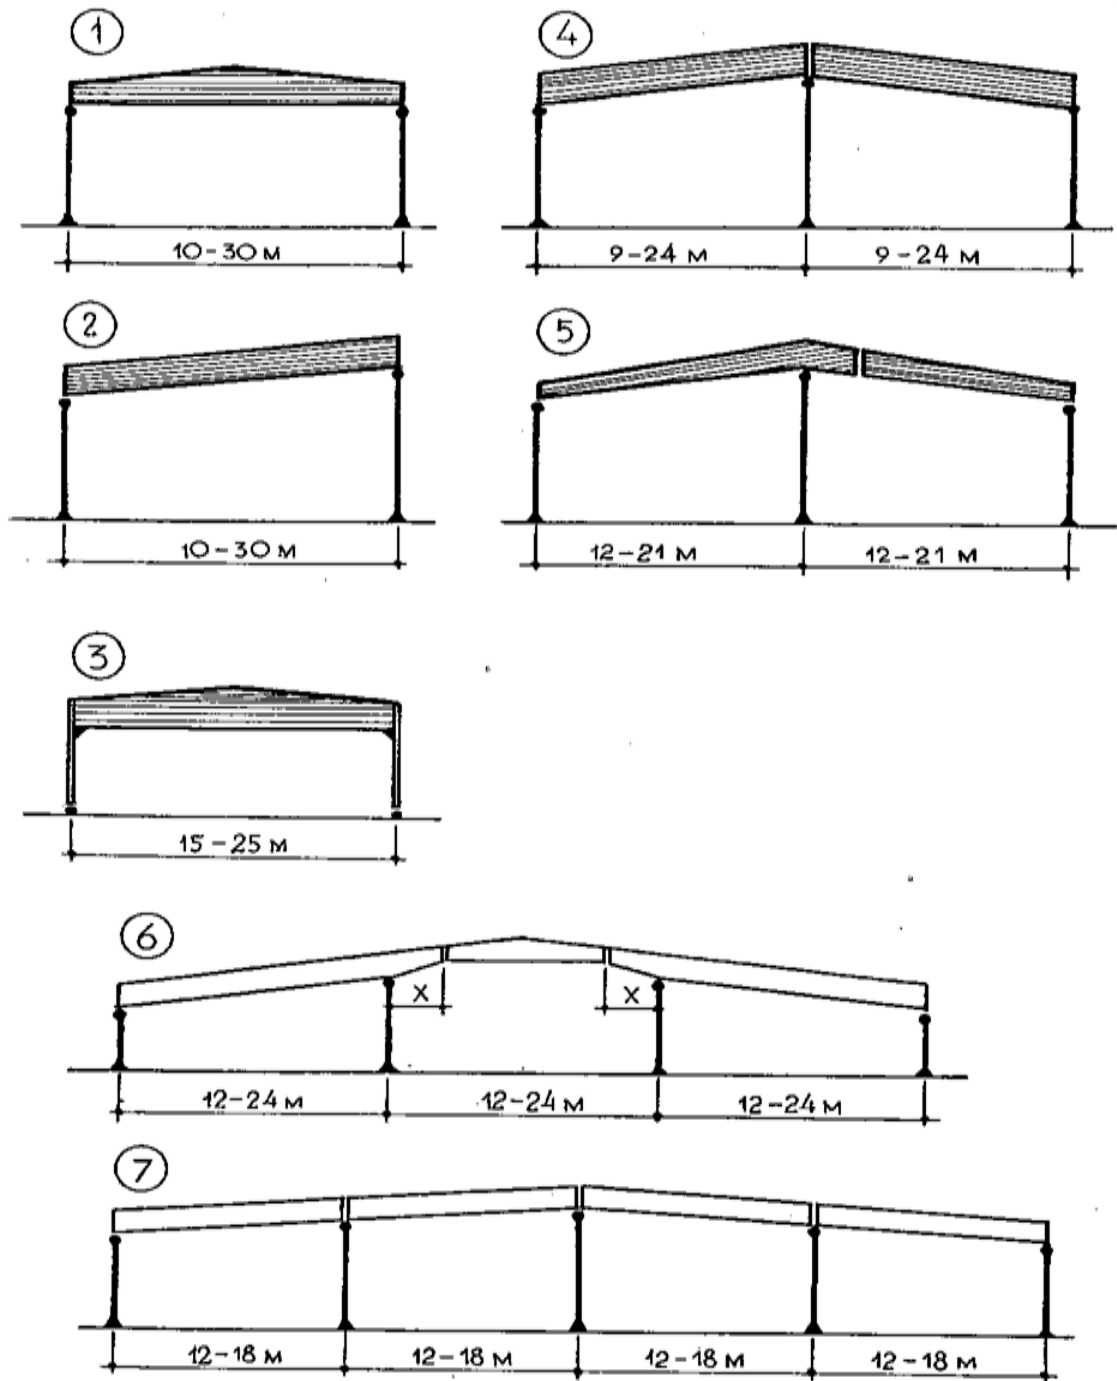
Схемы поперечников каркасных зданий с ригелем из клееных деревянных балок:
